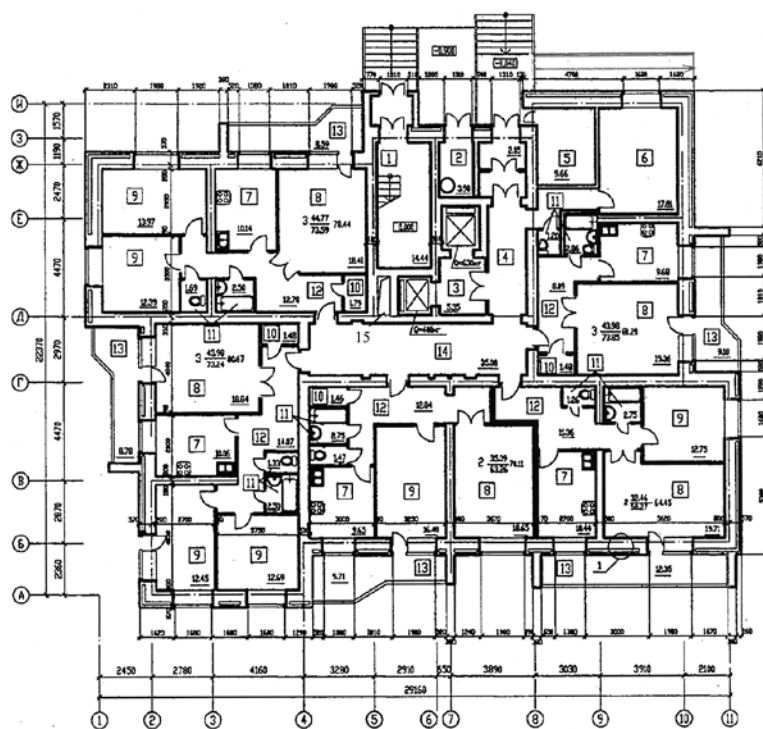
План первого этажа жилого 16-ти этажного кирпичного дома
